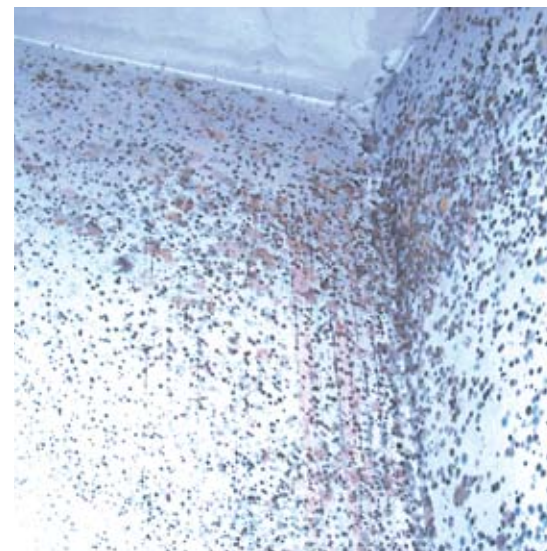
| Großflächiger Schimmelbefall in einer Außenwanddecke
